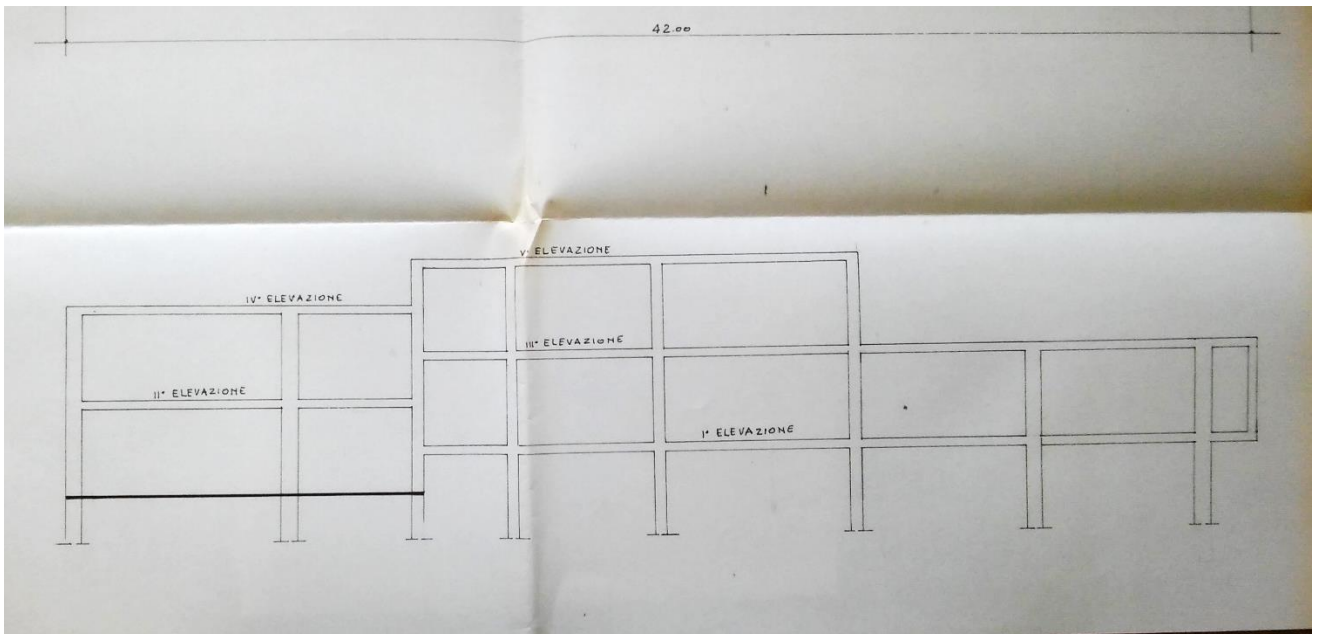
Dettaglio dal progetto strutturale del secondo stralcio – Livelli di elevazione – Sezione lato Ovest della scuola
